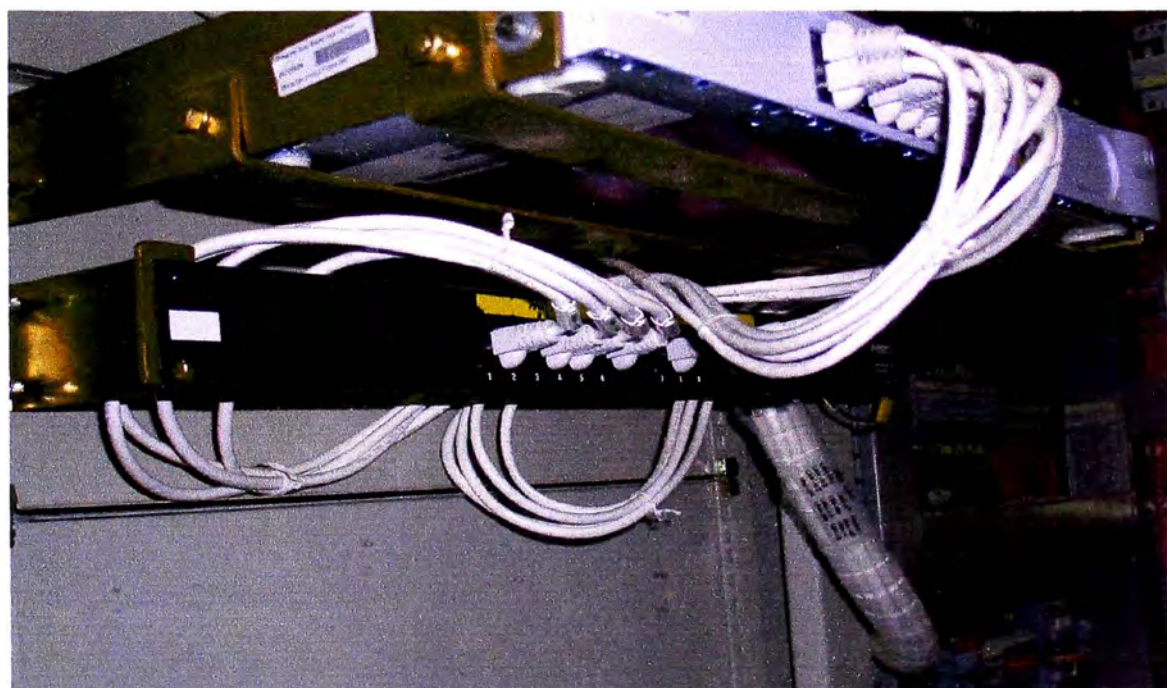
Conexión de red LAN en Hub y Patch panel de BC3
